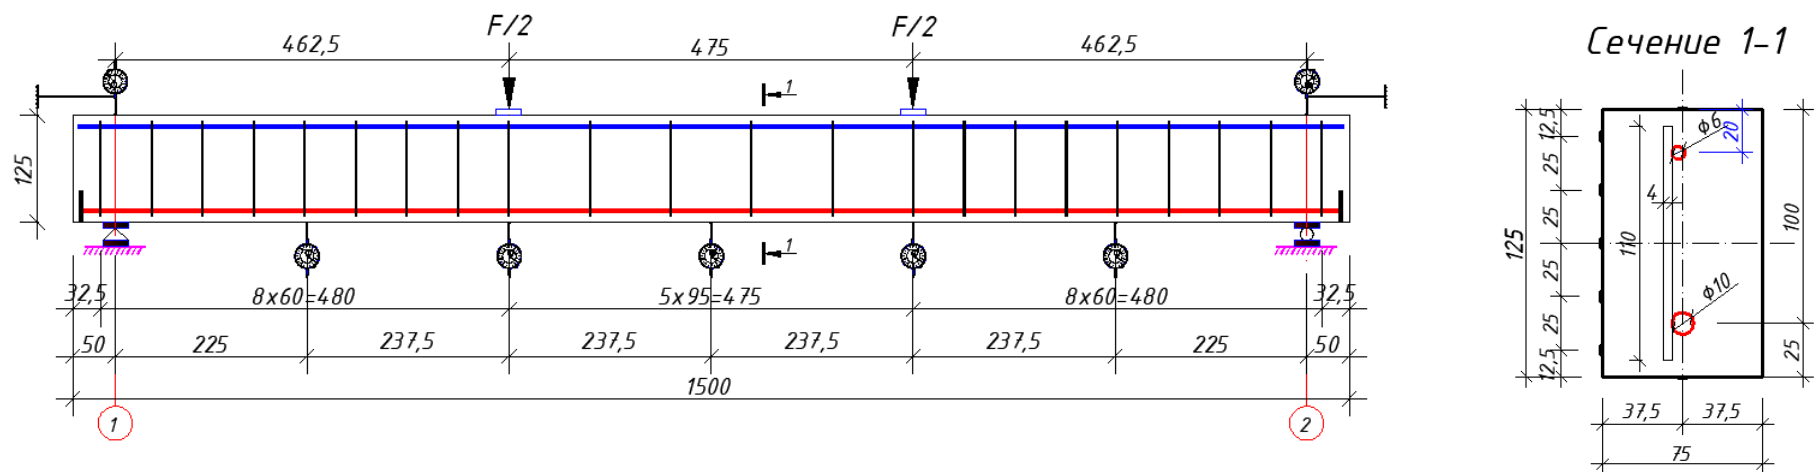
Расчётная схема модельных железобетонных балок с армированием
